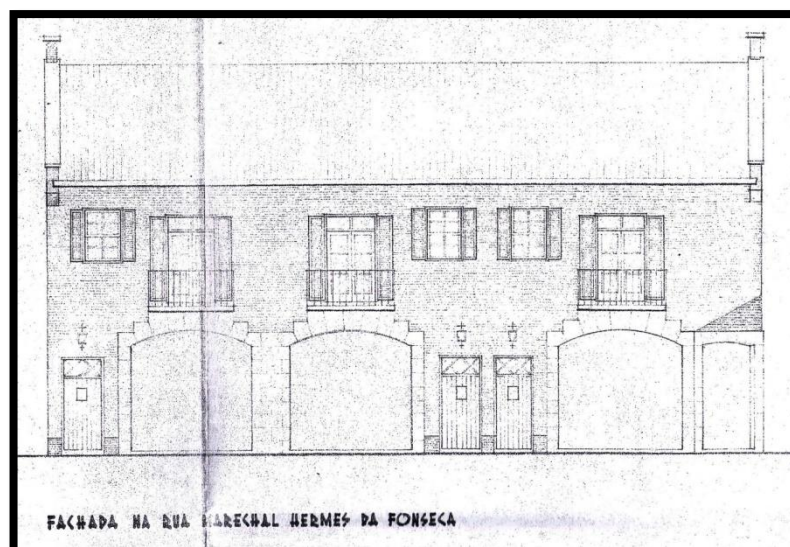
Projeto da fachada dos armazéns voltados para a Rua Marechal Hermes da Fonseca.
